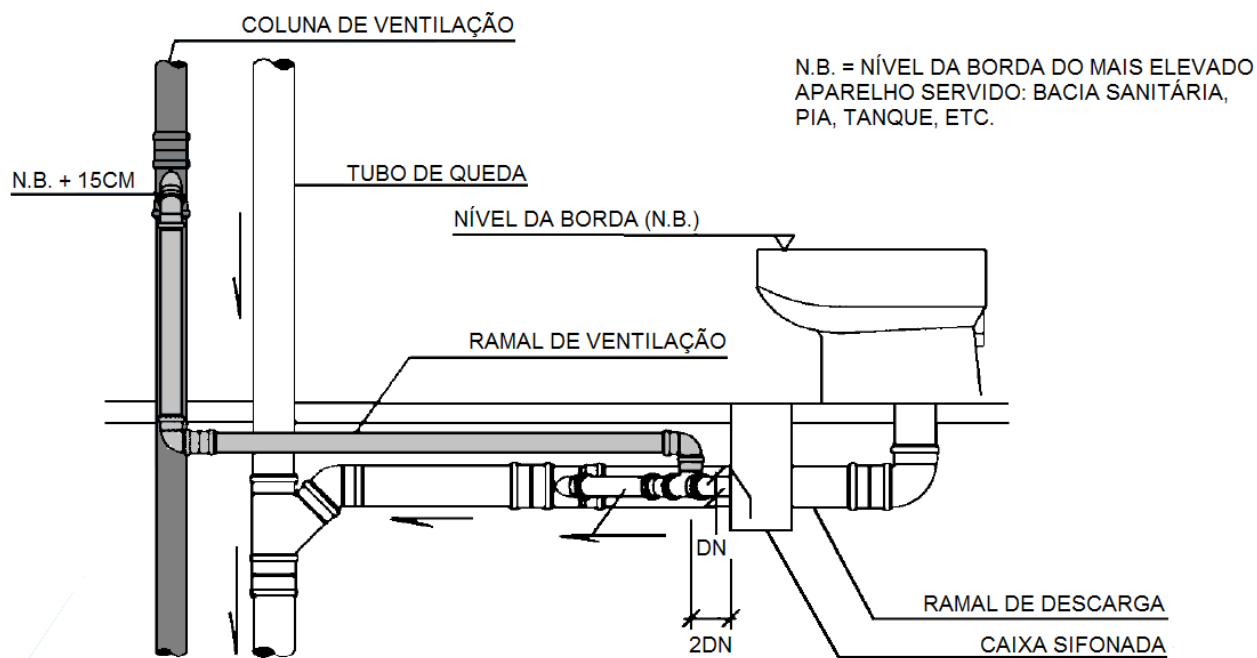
Ligação de ramal de ventilação (Fonte: Adaptado de NBR 8160, 1999).
